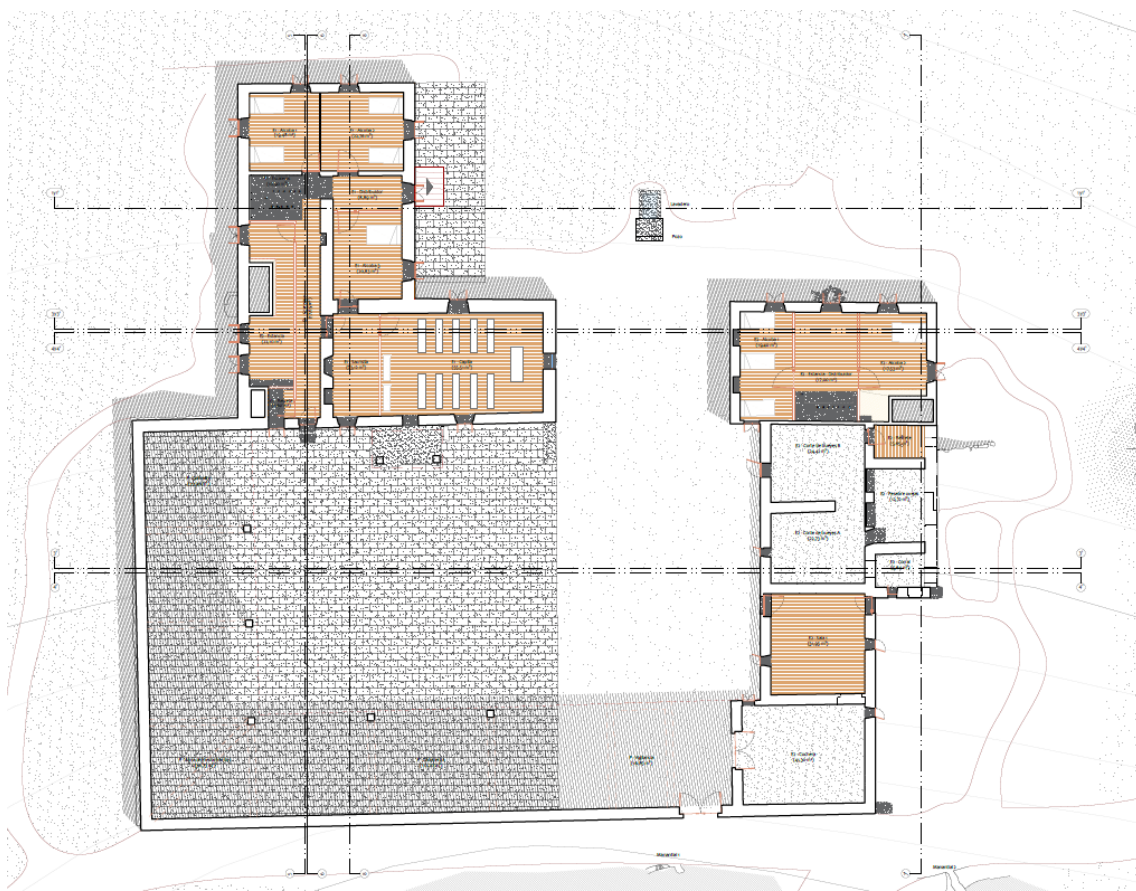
Reconstrucción interpretativa de la planta primera de este edificio.
